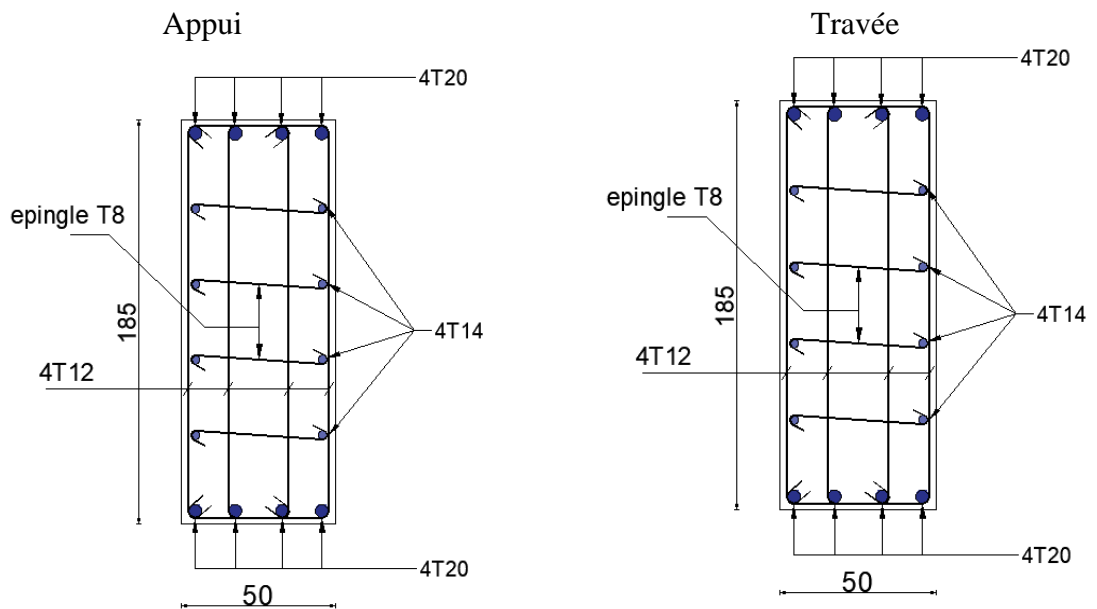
Schéma de ferrailage de la nervure sur sens y-y
